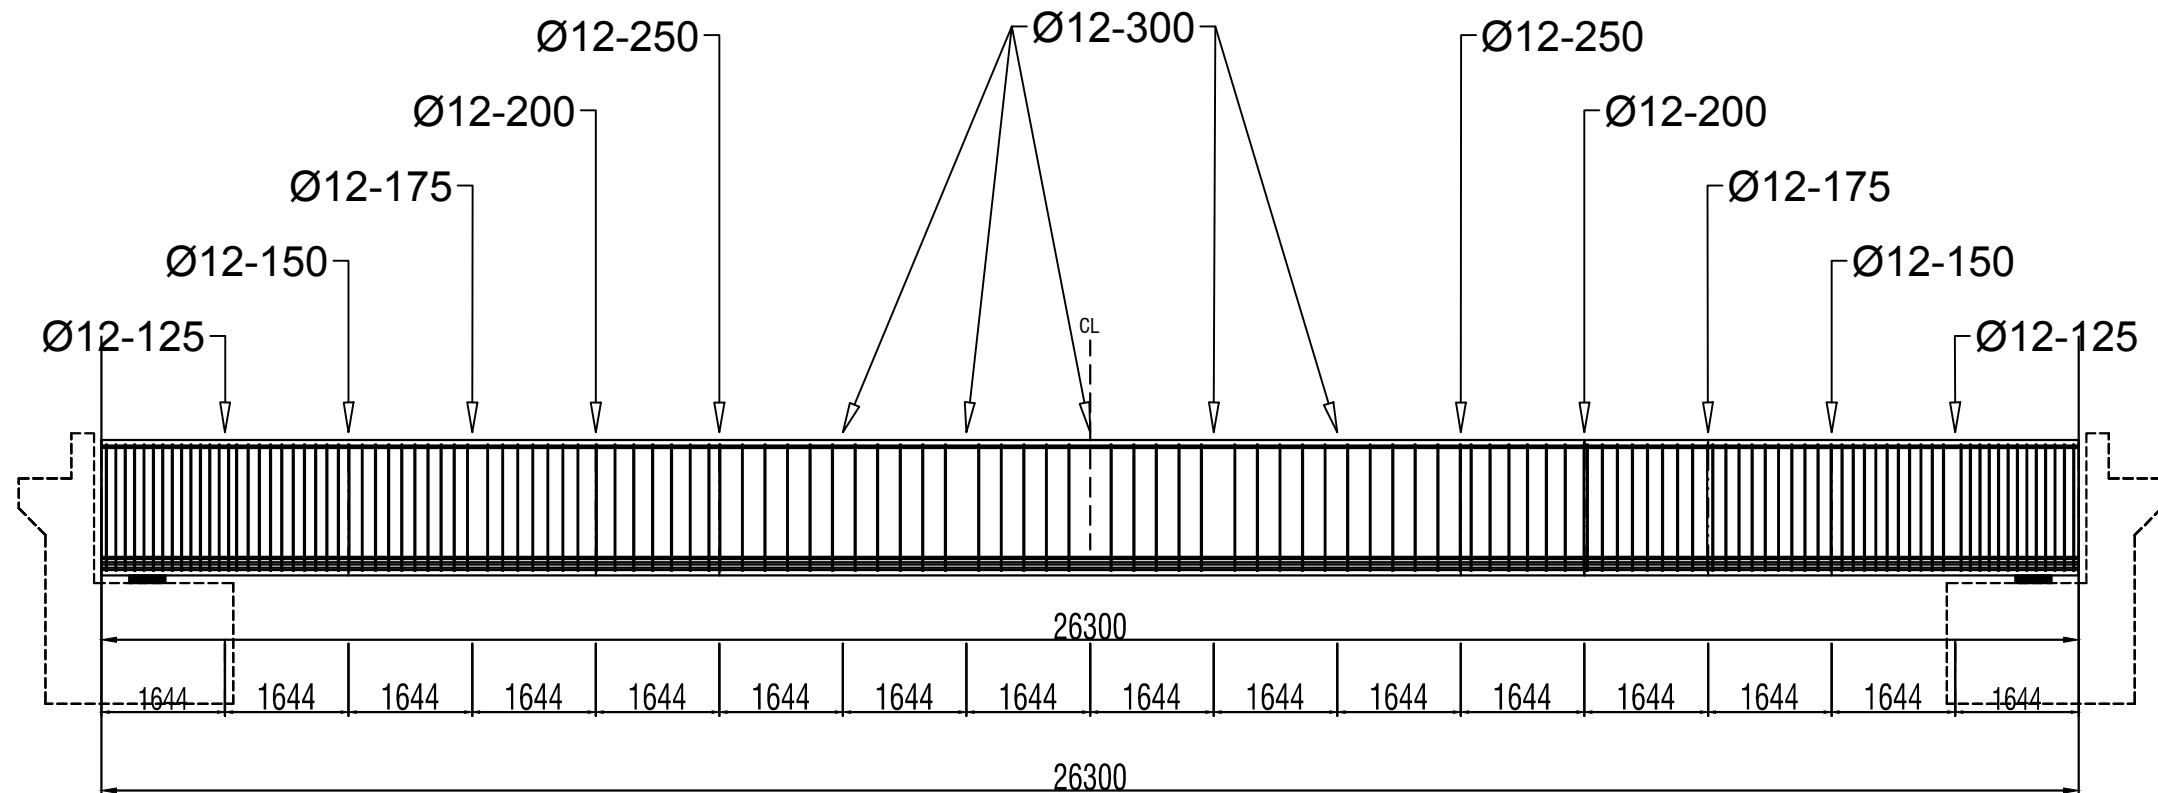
DETAIL POTONGAN GIRDER TEPI SKALA 1:50
